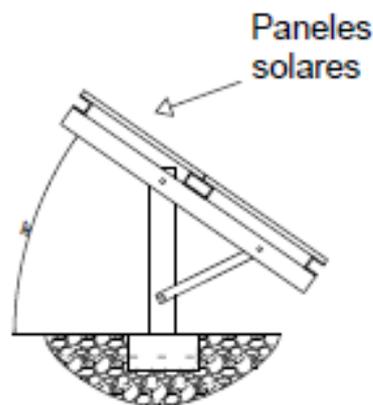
Perfil estructura metálica [Fuente Elaboración propia]
